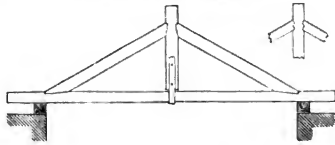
bis 208. Verbindung der einfachen Hängesäulen mit den Streben und dem Balken.
